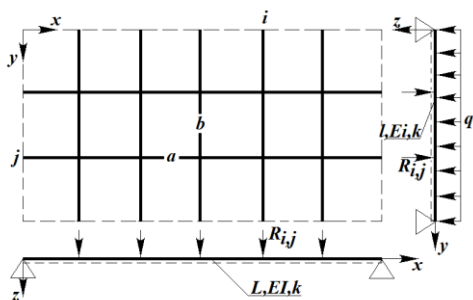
Расчетная схема регулярного перекрытия на СУО
